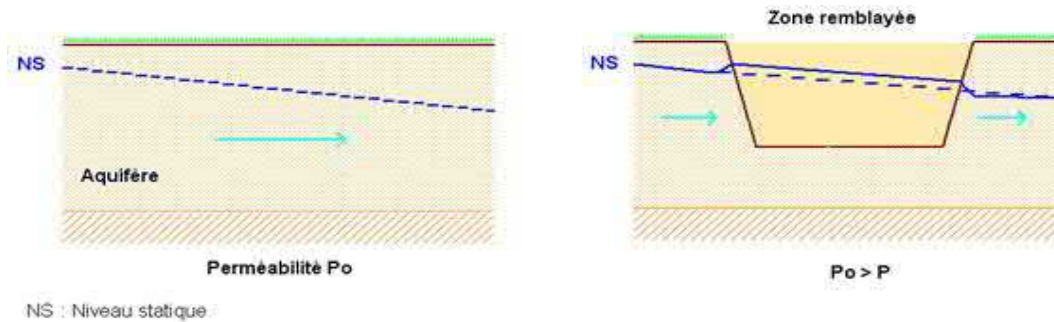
Illustration de l'effet de remblaiement d'un plan d'eau sur la nappe
